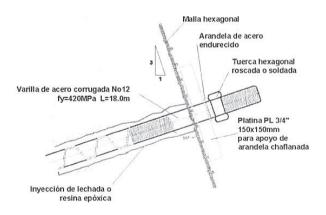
Brisas del Volador- Detalle Cabezal Anclaje
